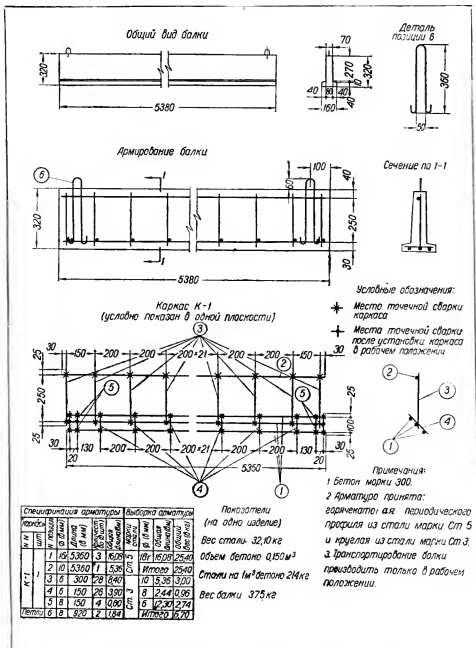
Конструктивный чертеж балки таврового сечения.
